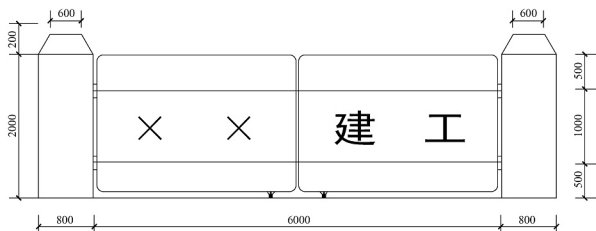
某项目部办公区无门楼式大门立面图 (单位: mm)
